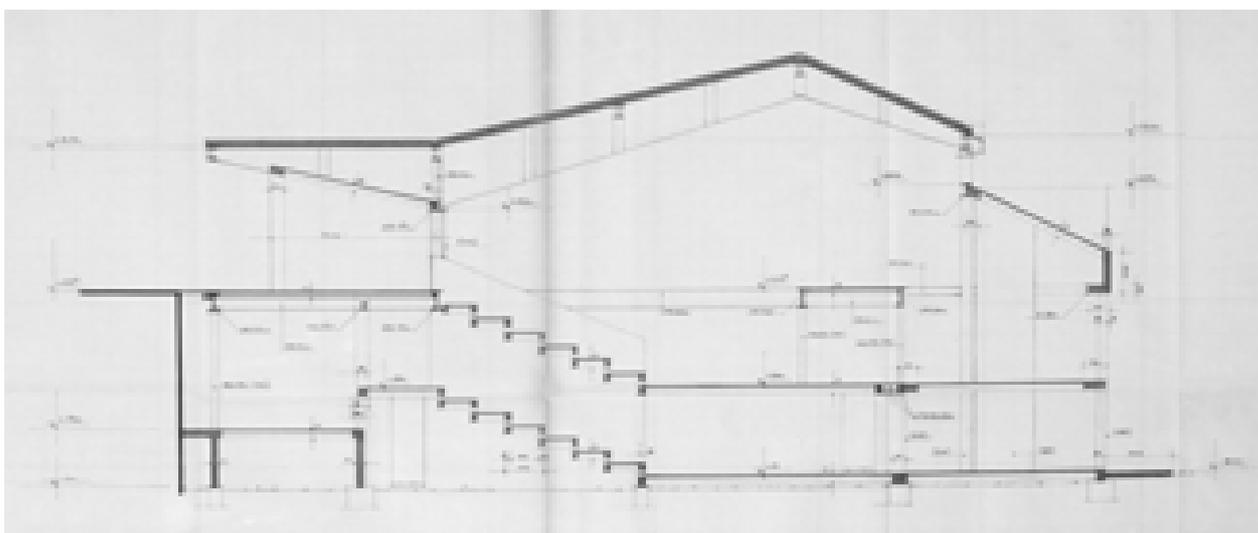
Sezione AA – OPEN –24/01/1990 (AABS-1996.229)
